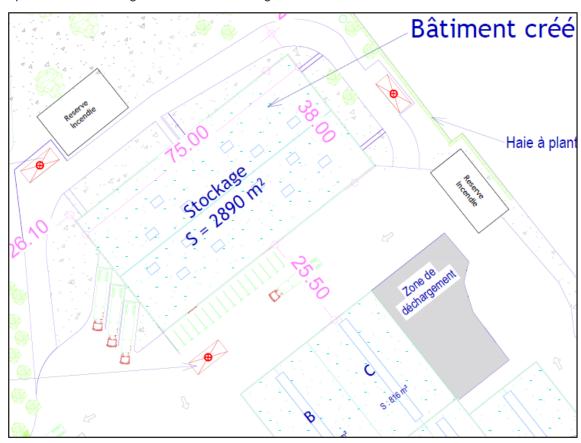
Aménagement futur de bâtiment (source : sicabconstruction)
